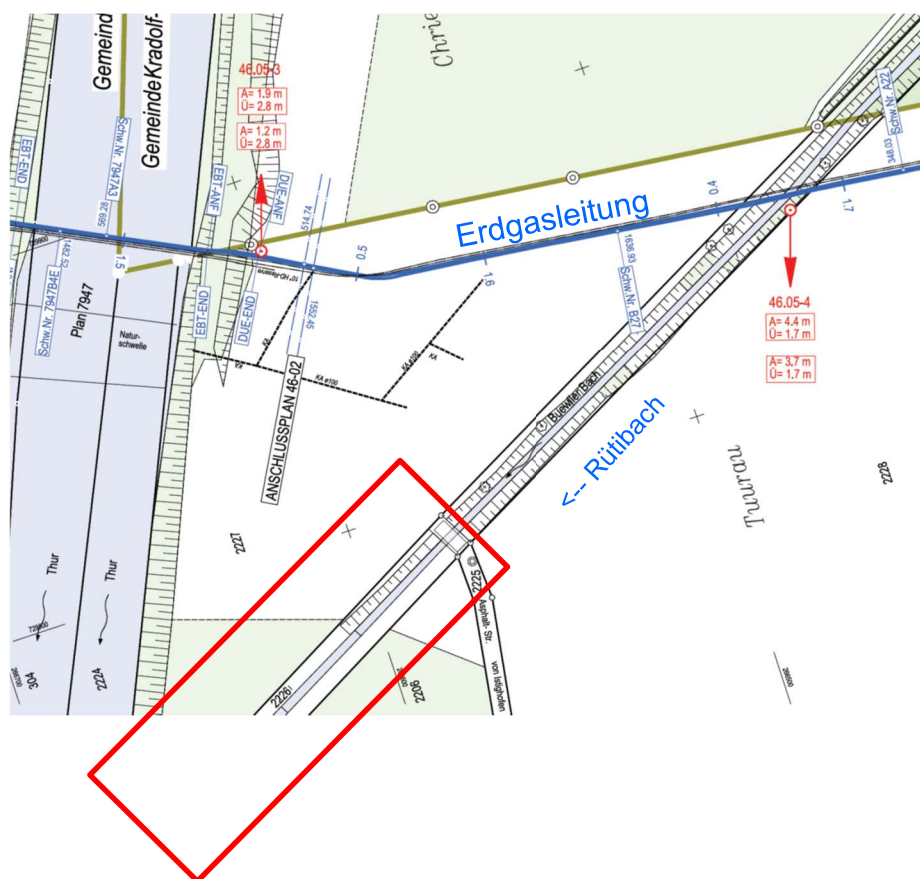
Erdgasleitung östlich des geplanten Projektes [Quelle: Erdgas Ostschweiz]
